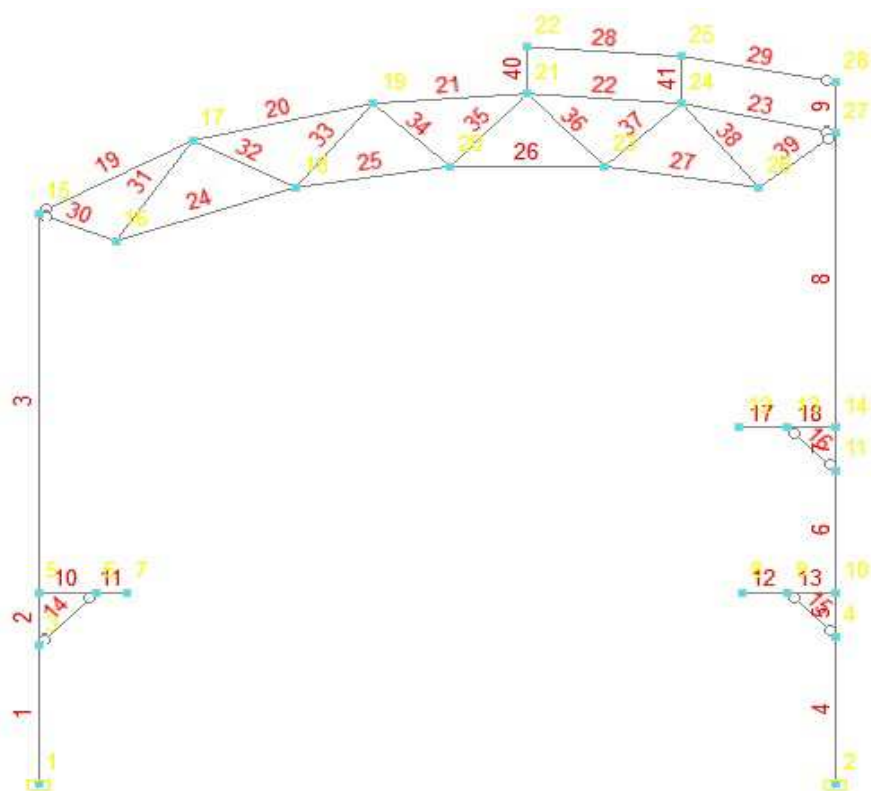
Расчетная схема поперечника блока №2 в осях В-И
